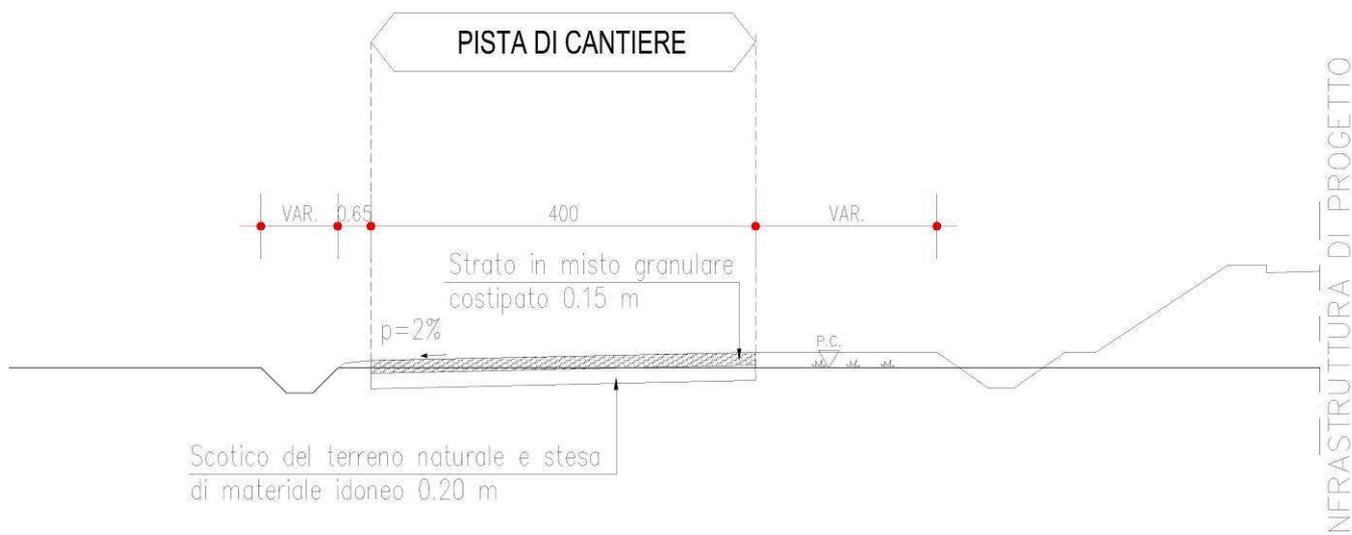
SEZIONE TIPO DELLE PISTE DI CANTIERE (ESTRATTO DALL'ELAB. T00CA00CANLF01A- TAV. 24)
